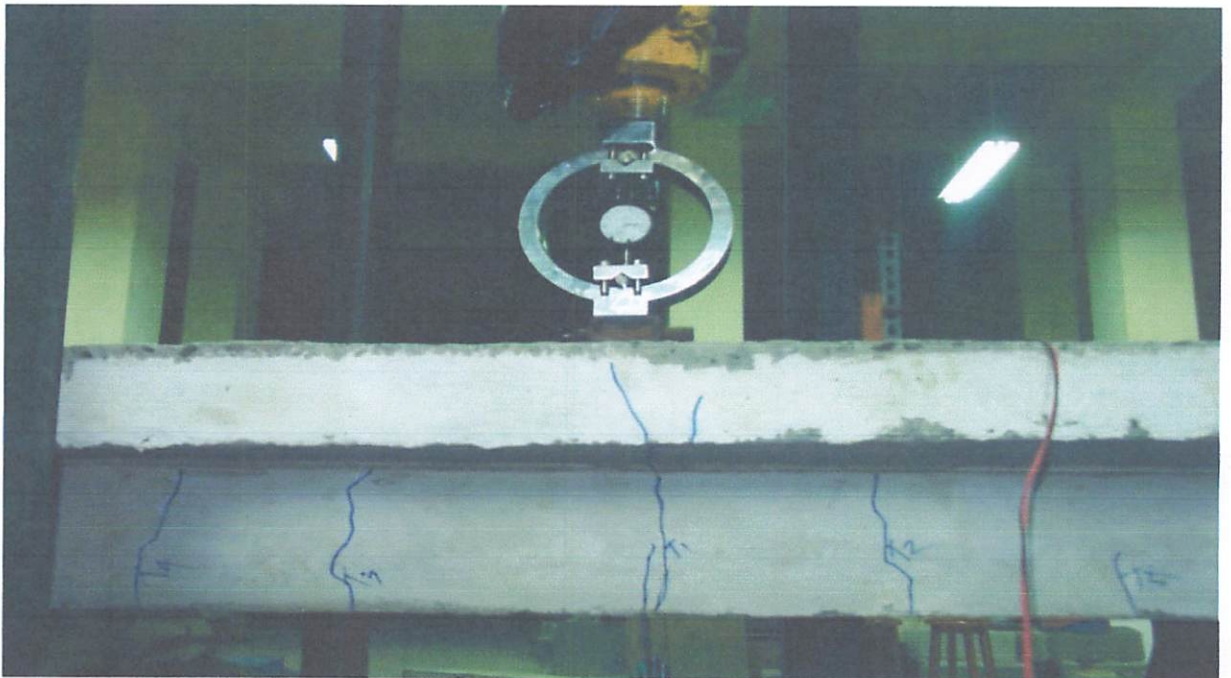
Retak yang terjadi pada balok T tanpa sambungan beton dan tulangan B (BTS-B)
